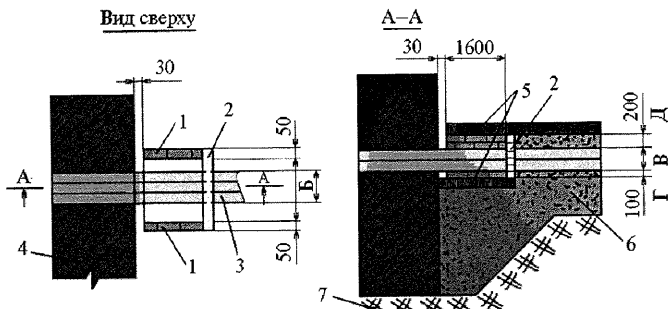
Защита трубы при выходе из фундамента в грунт
